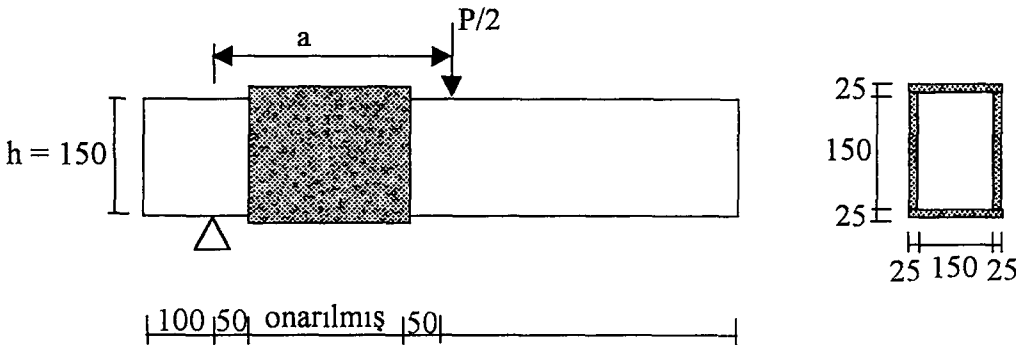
’de görüldüğü gibi eğilme etkisinde çatlatılmış bir betonarme kirişin çekme bölgesin klasik çelik plaka yerine Reaktif Pudra Betonundan yapılmış bir levha ile güçlendirilmektedir. Kullanılan reaktif pudra betonunun hacmen %6’ya varan oranda kısa kesilmiş 0.15 mm çapında 6 mm ve 13 mm boyunda çelik teller kullanılmaktadır. Levhalar çatlamış kirişe adesivlerle yapıştırılmaktadır. Kiriş tekrar yüklendiğinde çok yüksek dayanımlara erişilmektedir[21-22]. Bu tür güçlendirmenin kayma bölgesinde de yapılması olasıdır.
